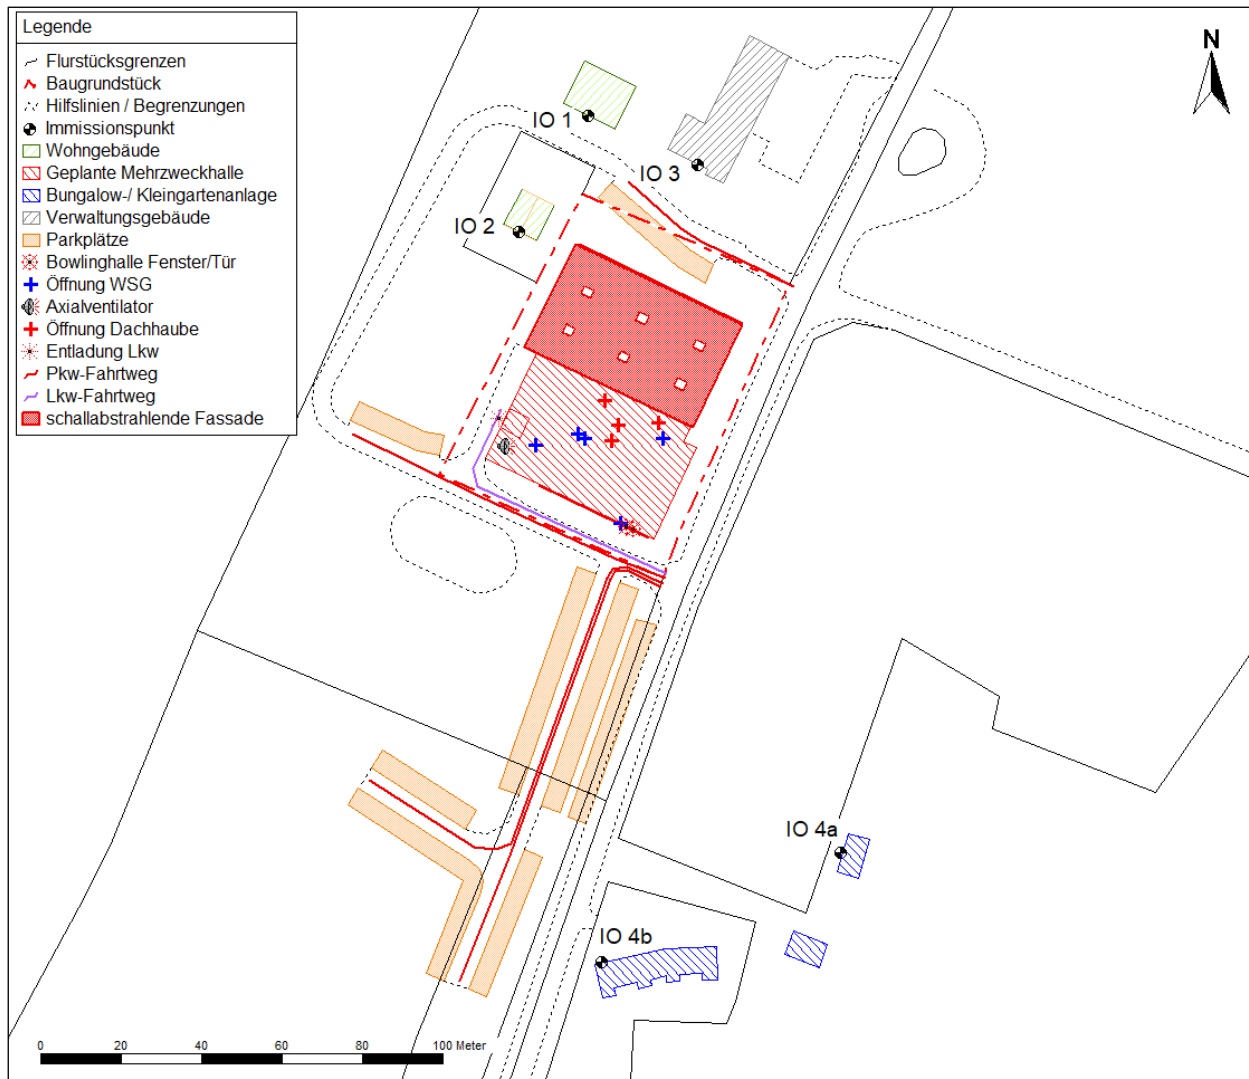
Lageplan des Rechenmodells mit Gebäuden, Schallquellen und Immissionsorten
